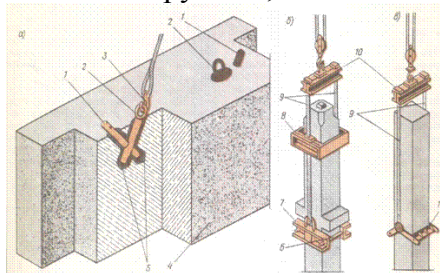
Захваты а — клиновой; б — рамочный; в — фрикционный; 1 — расclinка; 2 — захват с отверстием; 3 — крюк стропы; 4 — фундаментный блок; 5 — отверстия для установки захвата; 6 — выдвижной палец захвата; 7 — скоба захвата; 8 — направляющая рамка; 9 — стальные канаты; 10 — балочная траверса; 11 — вилочные стяжки
